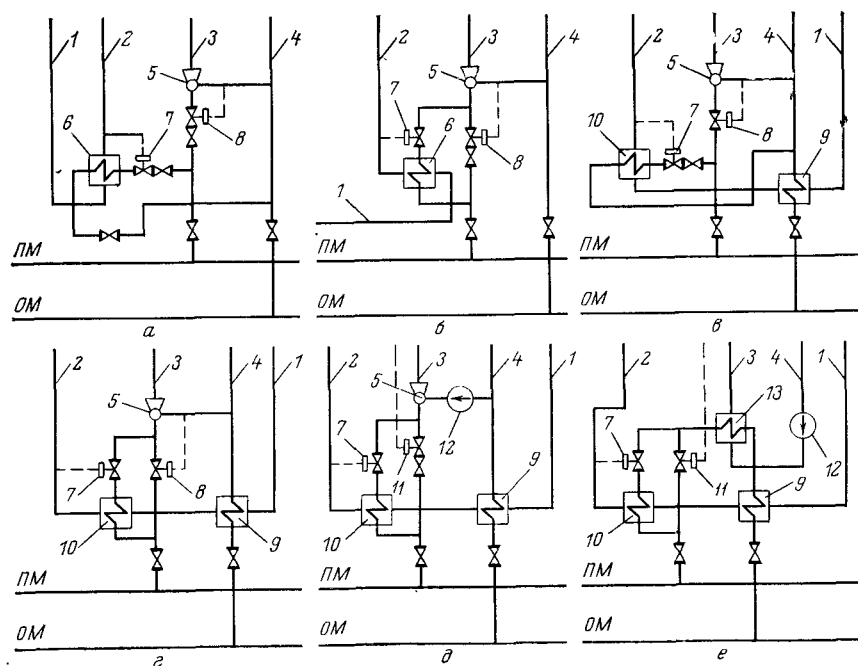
Подвод тепла на отопление, вентиляцию и бытовые нужды для закрытой схемы горячего водоснабжения с одним подогревателем водопроводной воды, подключенным параллельно отопительным устройствам (а); с одним подогревателем и регулятором, поддерживающим постоянный общий расход воды на теплофикацию (б); с двумя подогревателями, когда вторая ступень подогрева подключена параллельно отопительным батареям (в); с двухступенчатым подогревом водопроводной воды при постоянном общем расходе сетевой воды (г) и зависимой (д) и независимой (е) схемах с регулированием отопительной нагрузки по температуре воздуха при закрытой системе горячего водоснабжения.
